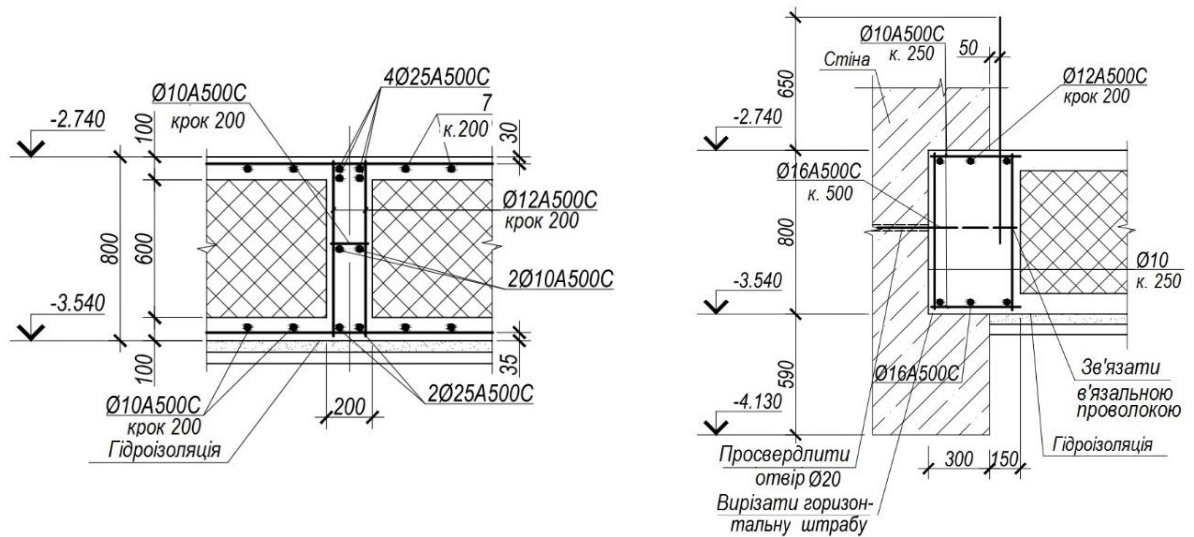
Вузли влаштування та обпирання на стіни фундаменту товщиною 800мм
